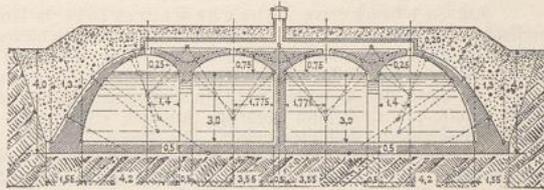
Betonwasserreservoir in Reichenbach i. V.
